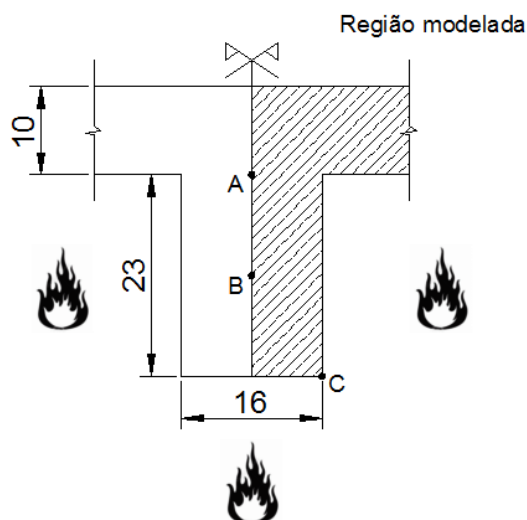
Esquema de exposição ao fogo da viga e da laje de concreto.
